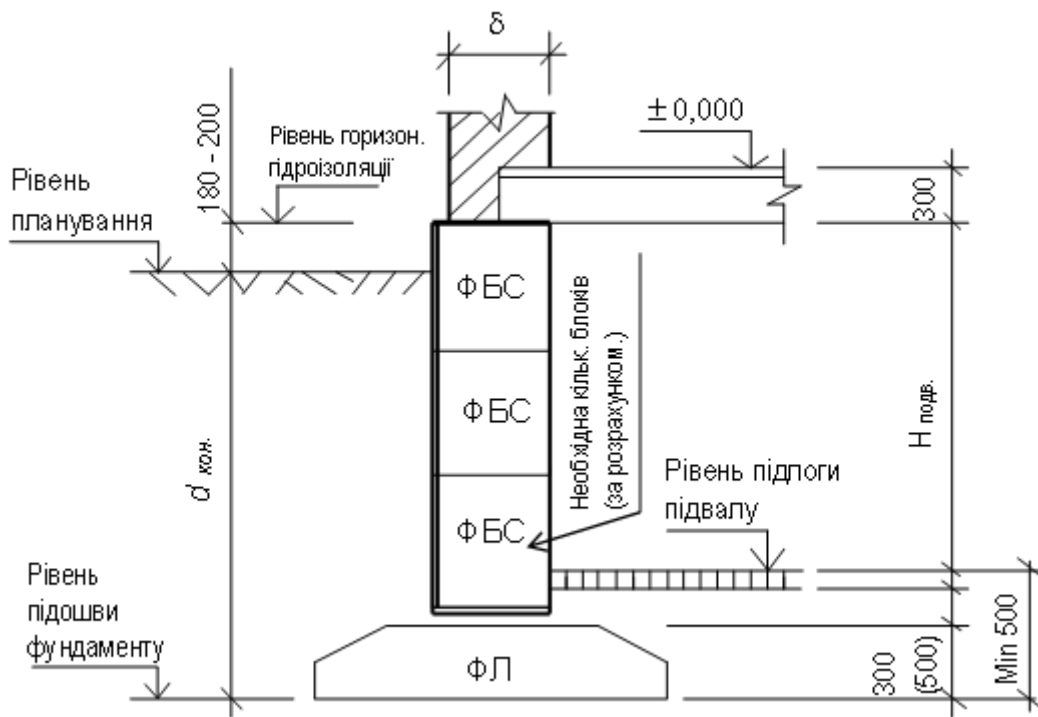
Попереднє конструювання стрічкового фундаменту (збірний з підвалом)
